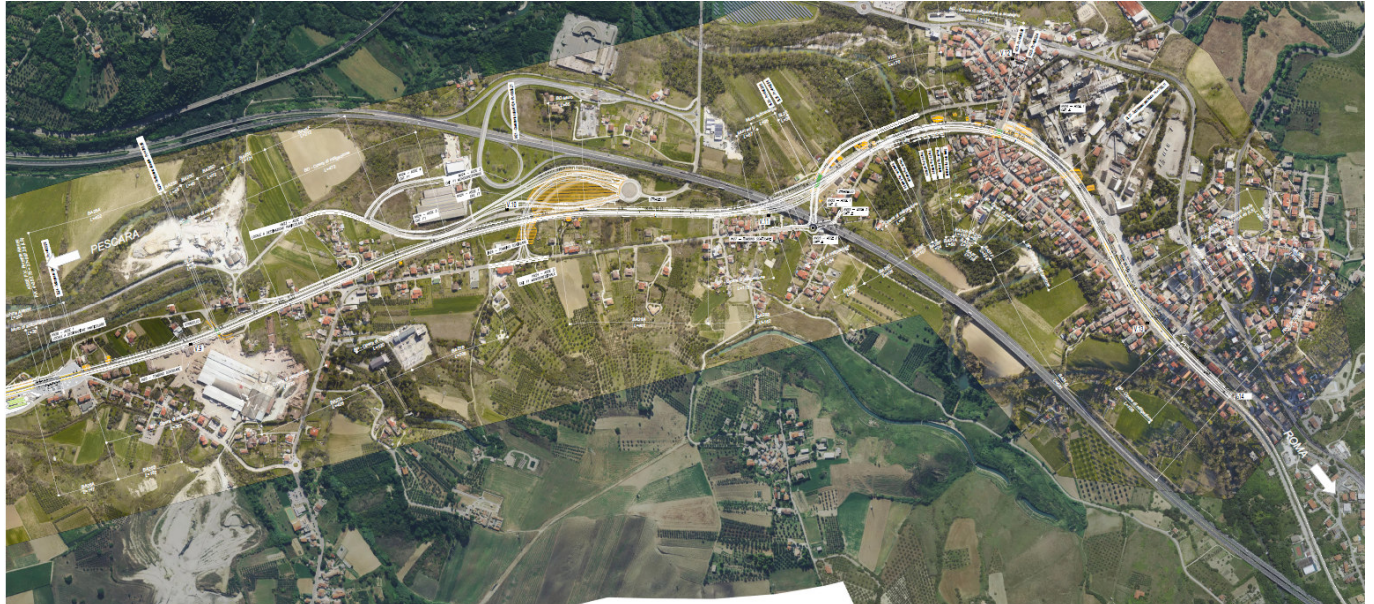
Inquadramento planimetrico su ortofoto – 3 di 3
